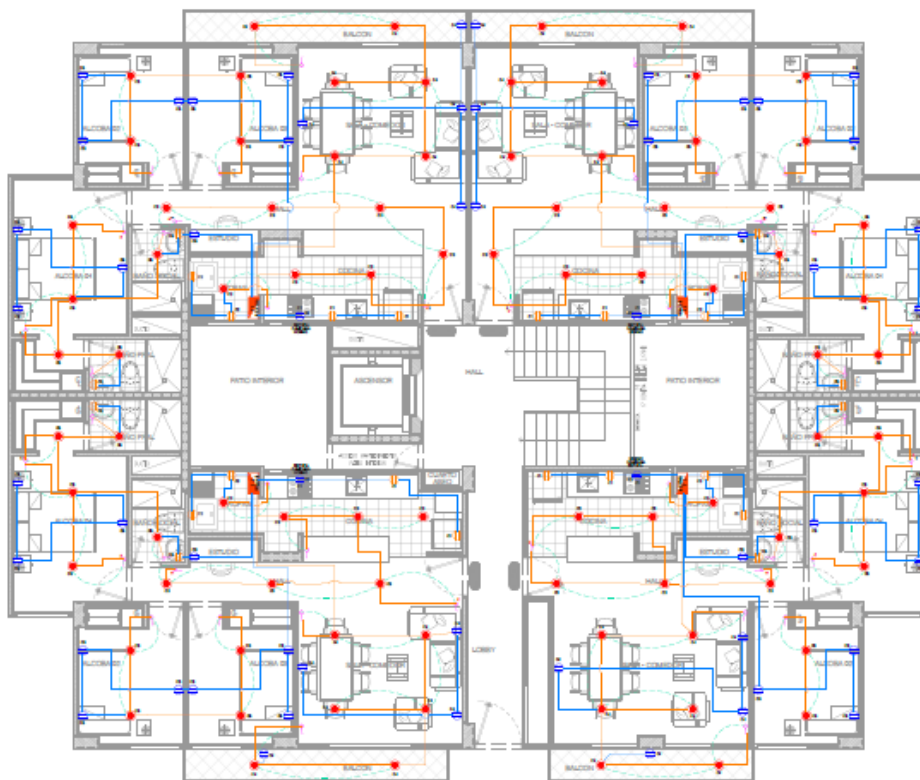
Plano Hidráulico. Suministro Piso 2 al 8
